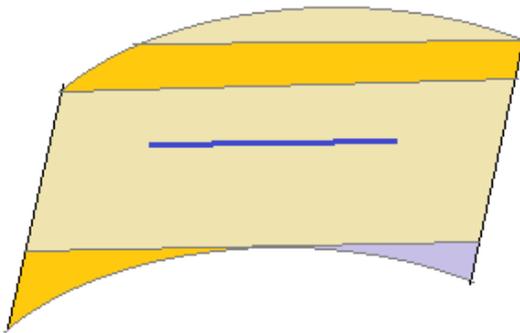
definición de las bandas de armado longitudinales.
